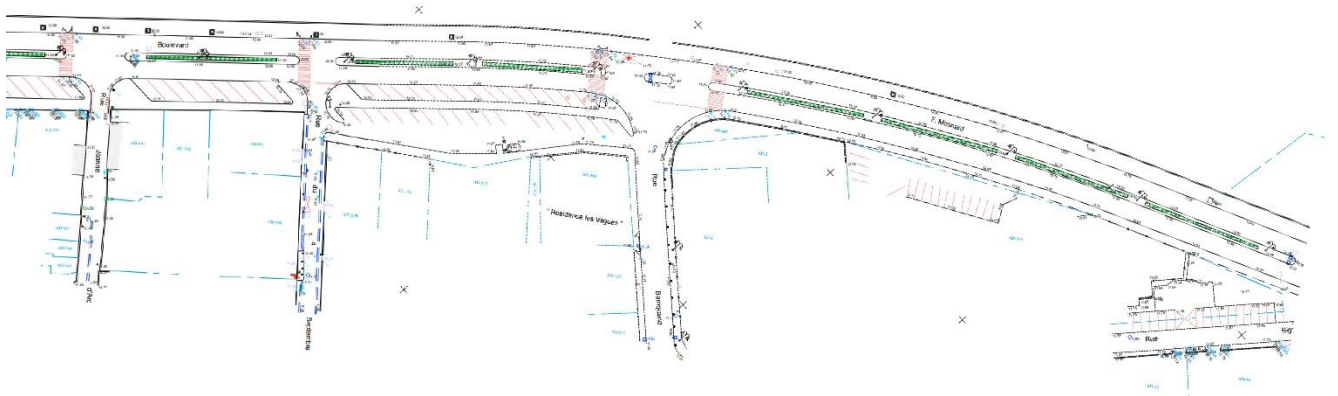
Plans de l'existant avant travaux (portion 3) (Source : PRO -juin 2018)
